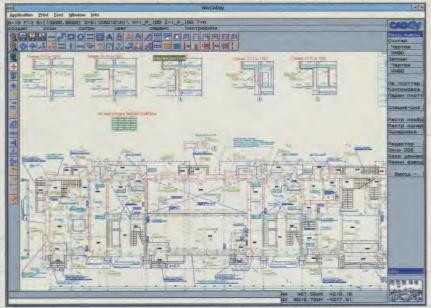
Фрагмент плана 1-го этажа жилого дома на сборном «столе», Москва, проспект Жукова (строится)
